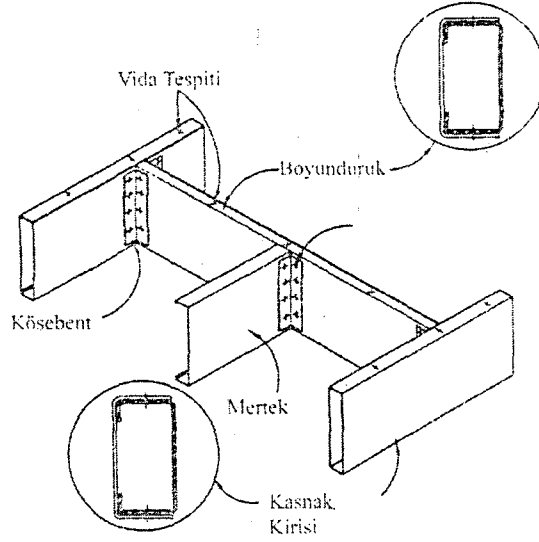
Tavan kirişinde ek yapılması (NASFA,2000)
